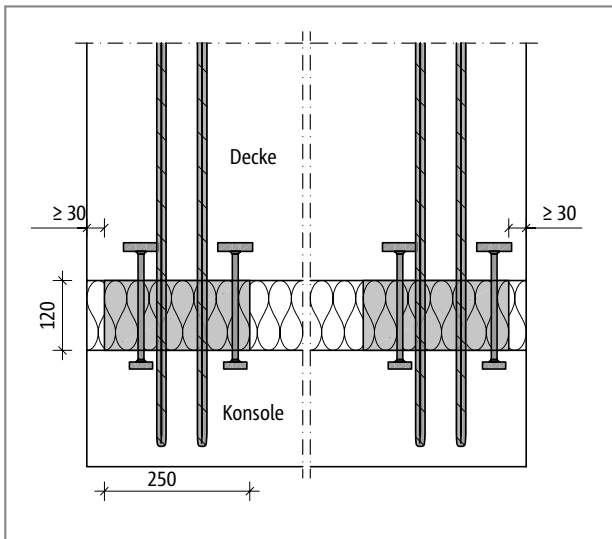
Schöck Isokorb® XT Typ O: Einzuhaltender Randabstand
